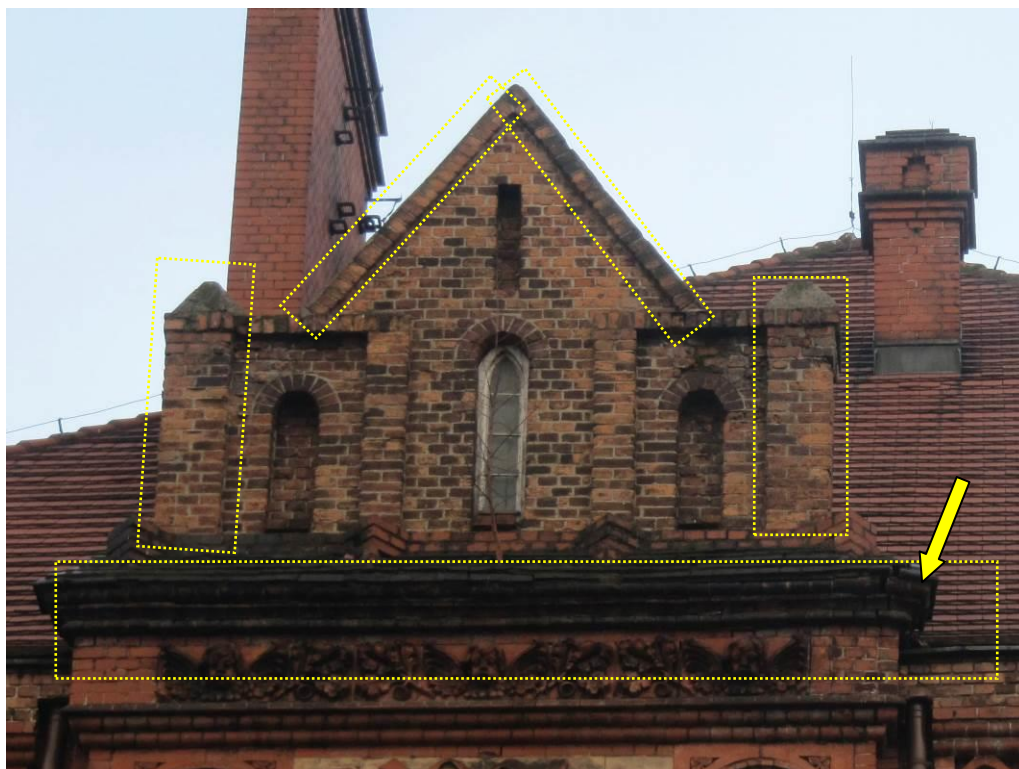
Górny fragment szczytu wieńczącego ryzalit fasady; zły stan skrajnych pilastrów
